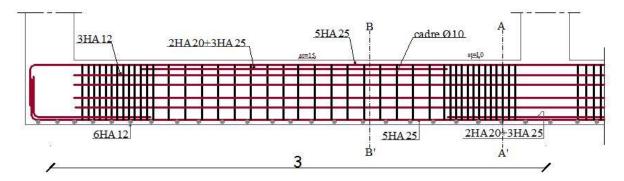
schéma de ferraillage de la semelle filante (coupe longitudinal).
